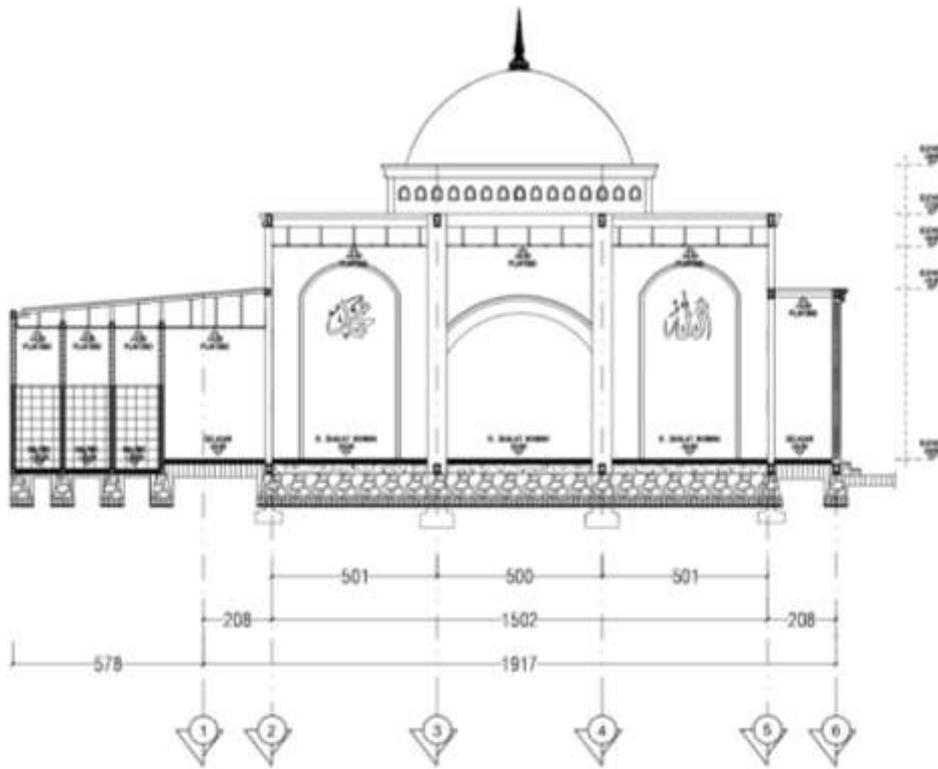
Gambar Tampak Depan Rencana Re-Design
